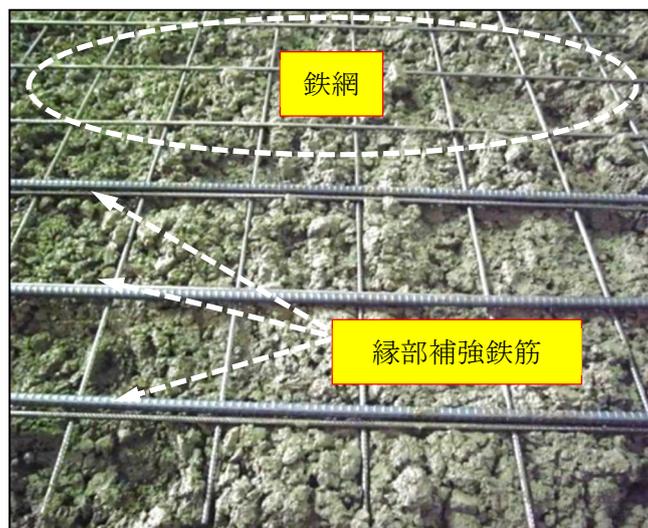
鉄網および縁部補強鉄筋の配置状況
